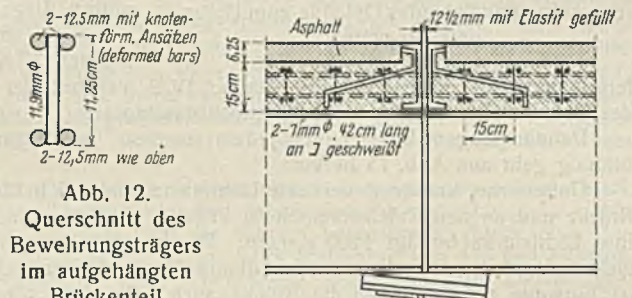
Querschnitt des Bewehrungsträgers im aufgehängten Brückenteil.
